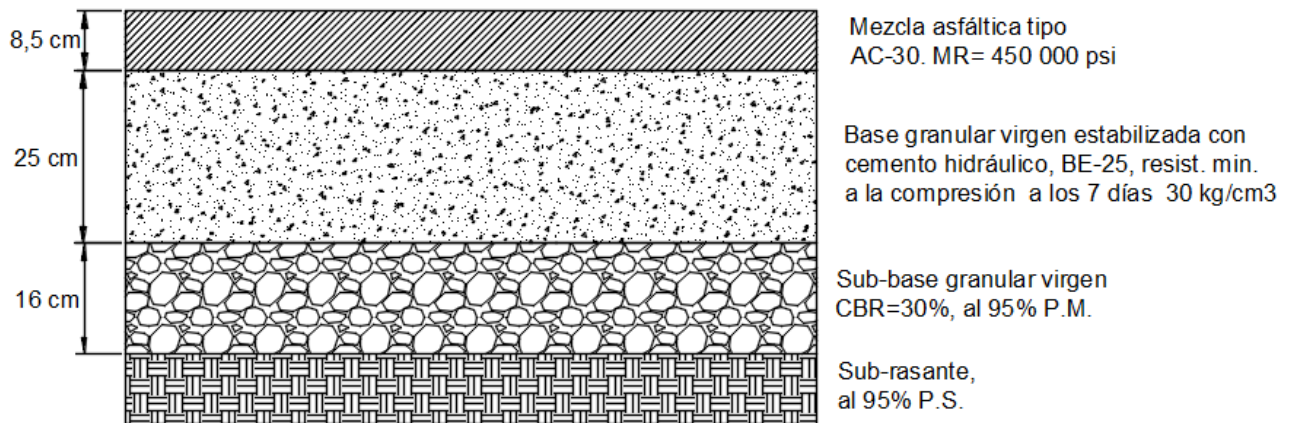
Perfil de la estructura de pavimento propuesta para el TH=2, 10 años.
